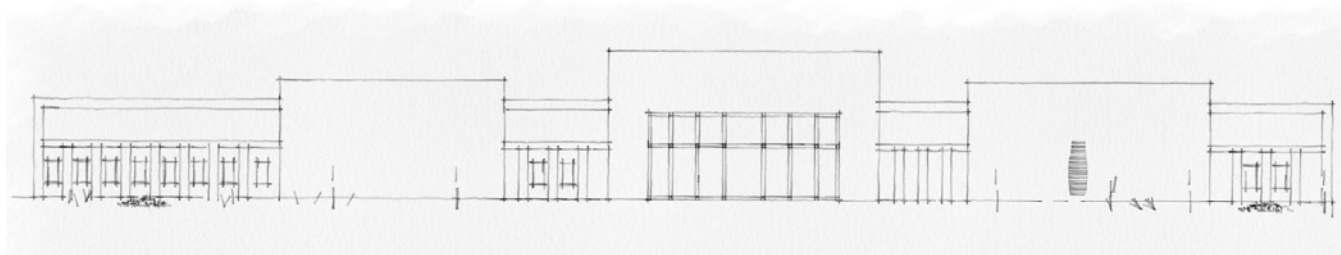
Boceto de fachada de acceso general para proyecto. Sin escala.
